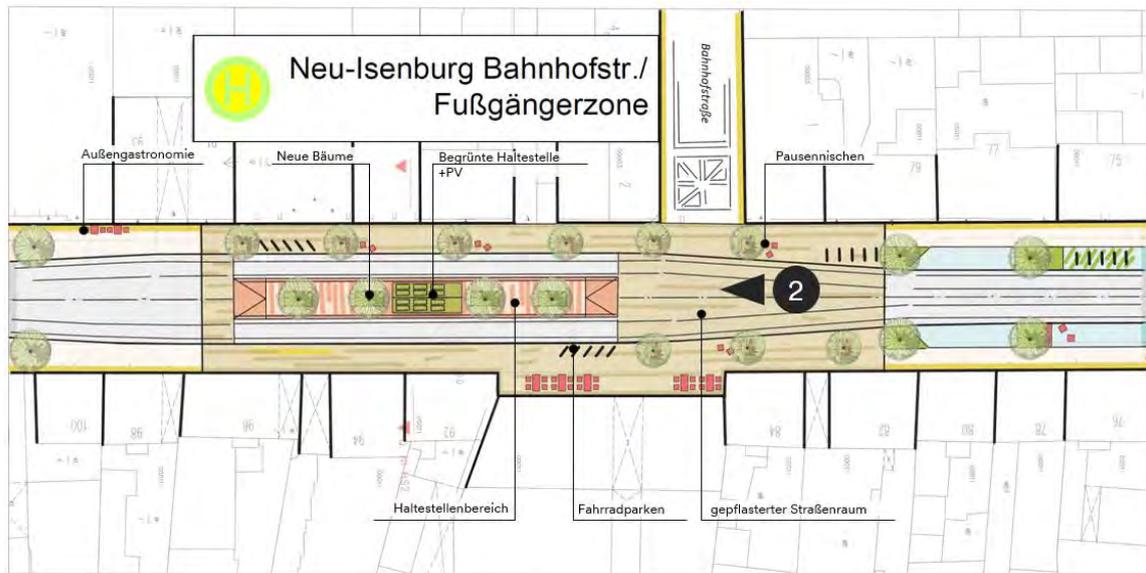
Lageplanskizze (Quelle Ramboll)
